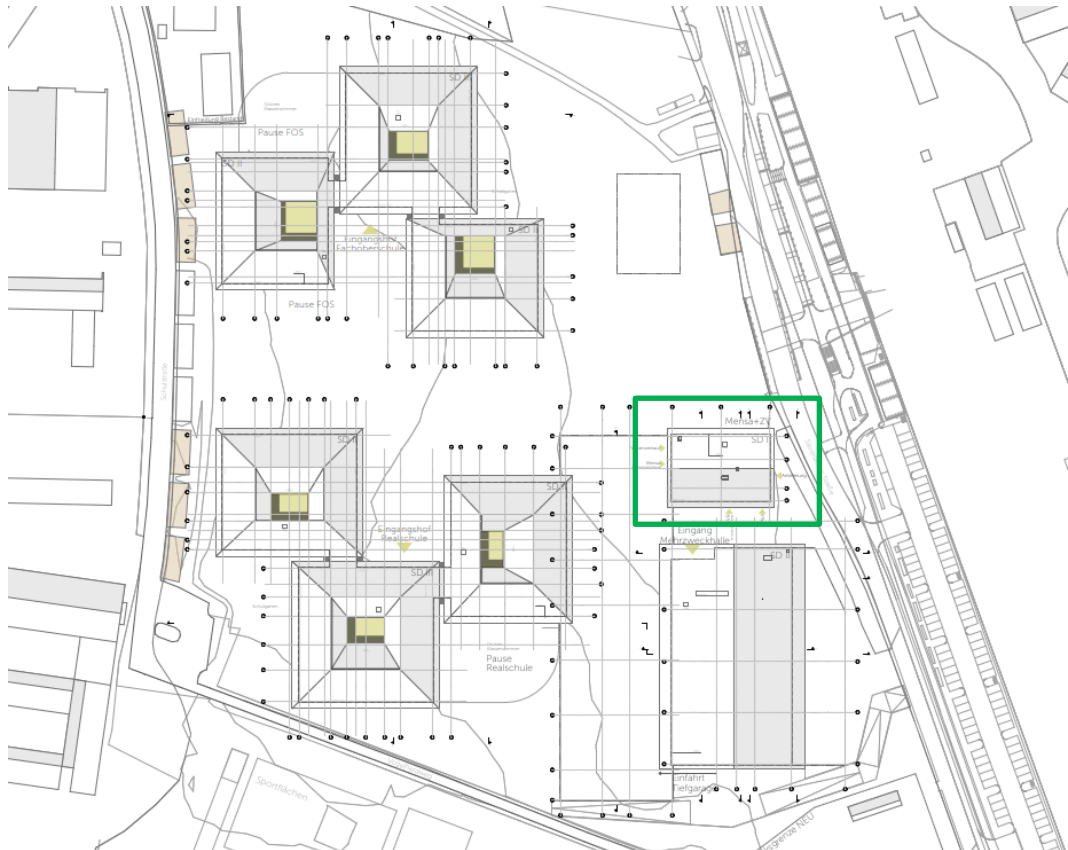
Ausschnitt aus dem genordeten Lageplan, Mensa grün markiert.
